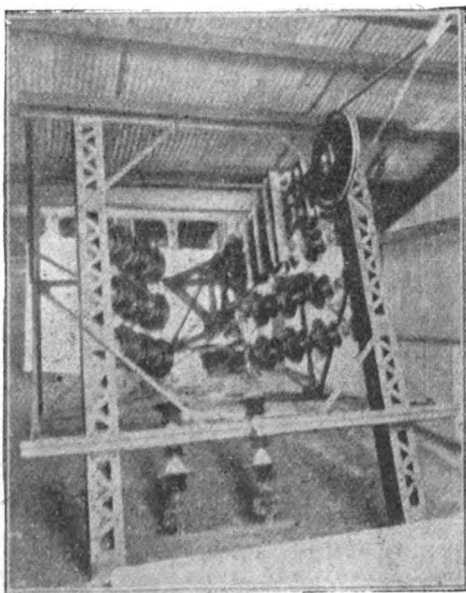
Vista dell'ancoraggio dalla parte dell'attacco del cavo.
